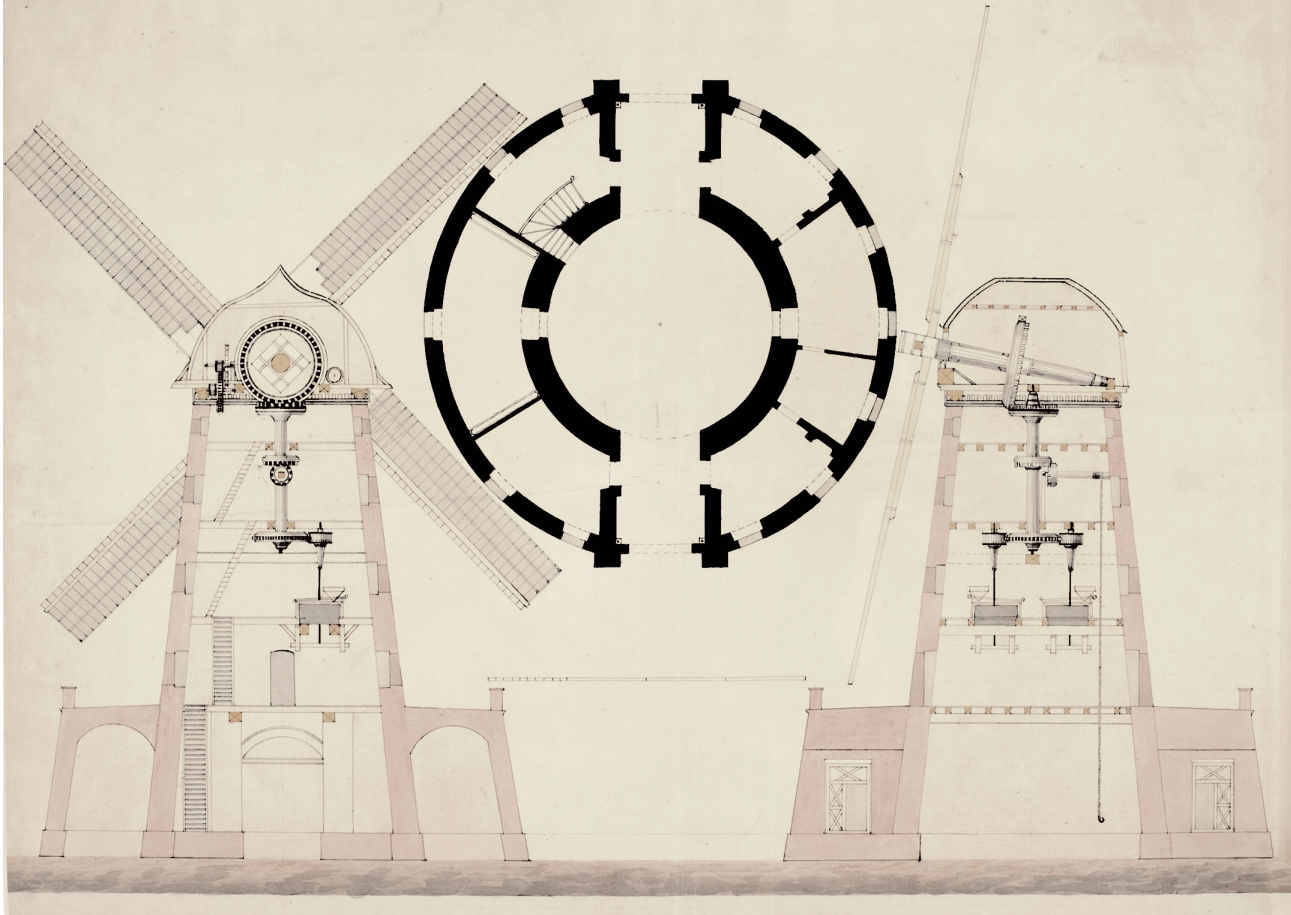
Grundriss, Schnitt und Aufriss der Mannheimer Windmühle.
